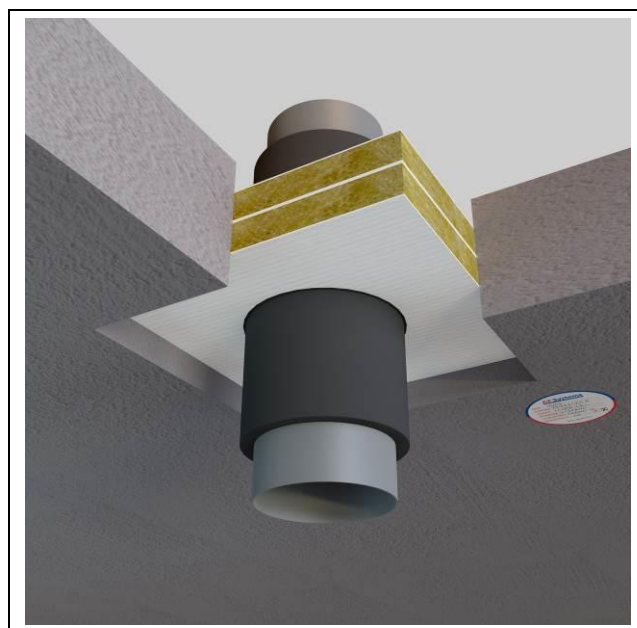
Exemple de joint AF PANEL dans un plancher rigide (C).
